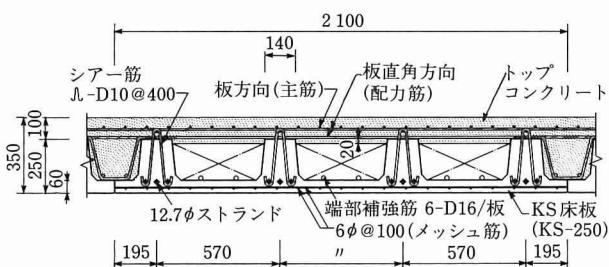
KS合成床断面詳細図(中空Type) (単位:mm)
